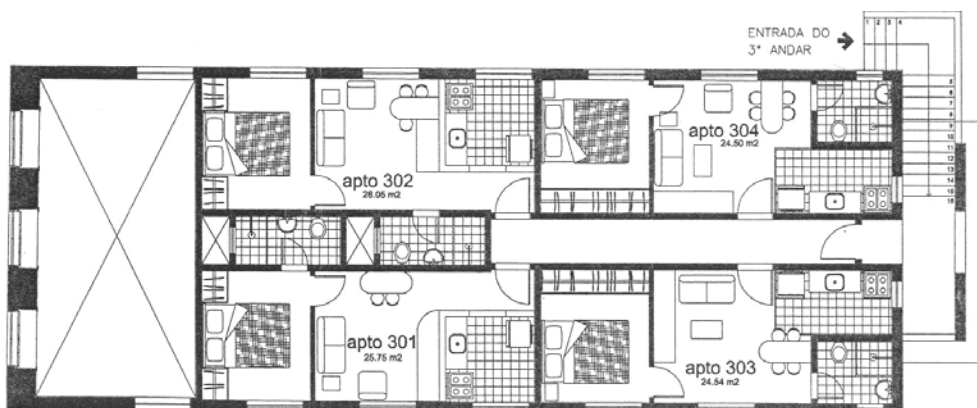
Rua Francisco Muratori, 38 – Planta baixa terceiro pavimento (FREIRE, 1999, p. 5).
